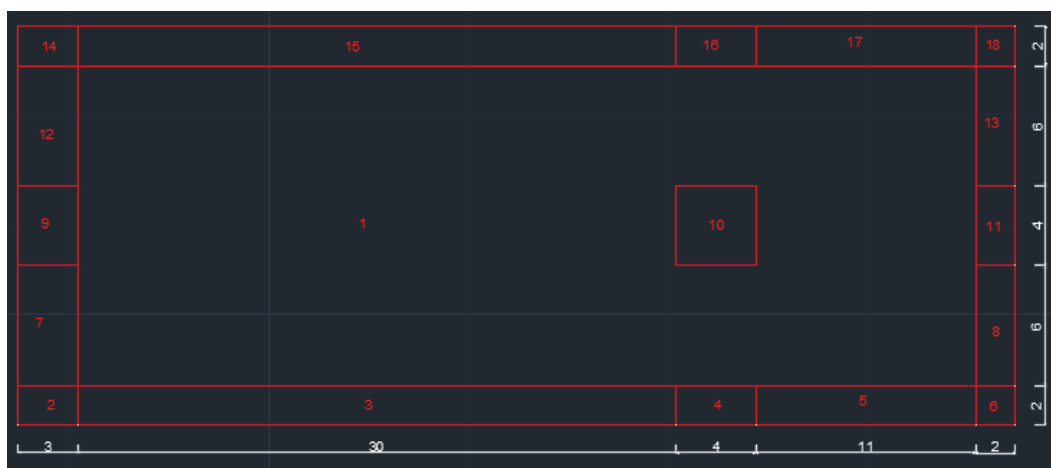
Numeración de zonas de armado (rojo) de la losa.
